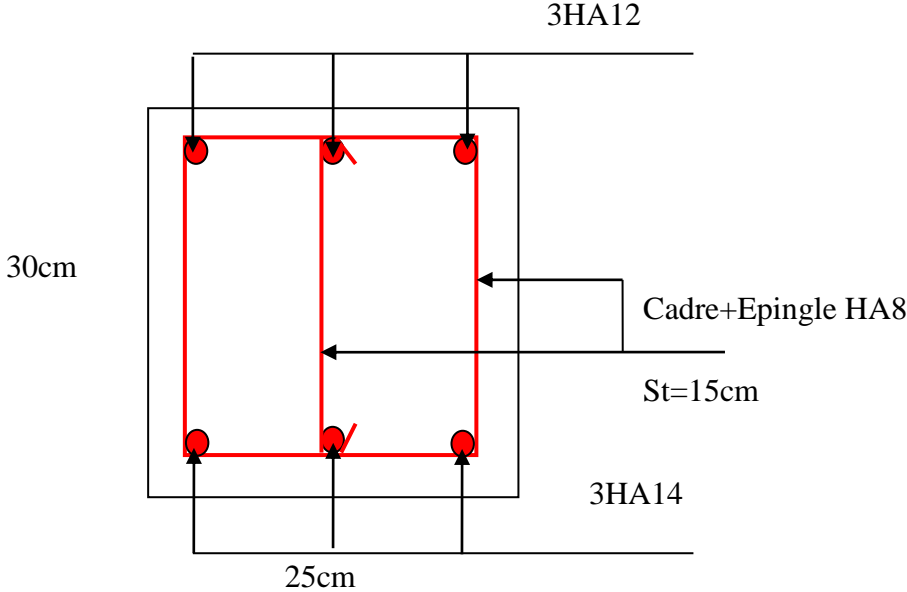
Schéma de ferrailage de la poutre de chaînage.
